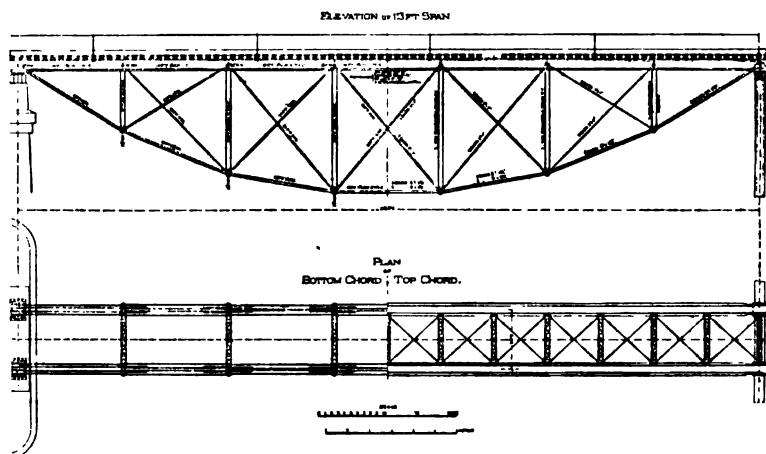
Dessins d'une travée d'accès de 34^m,47 du pont de Bismarck.
